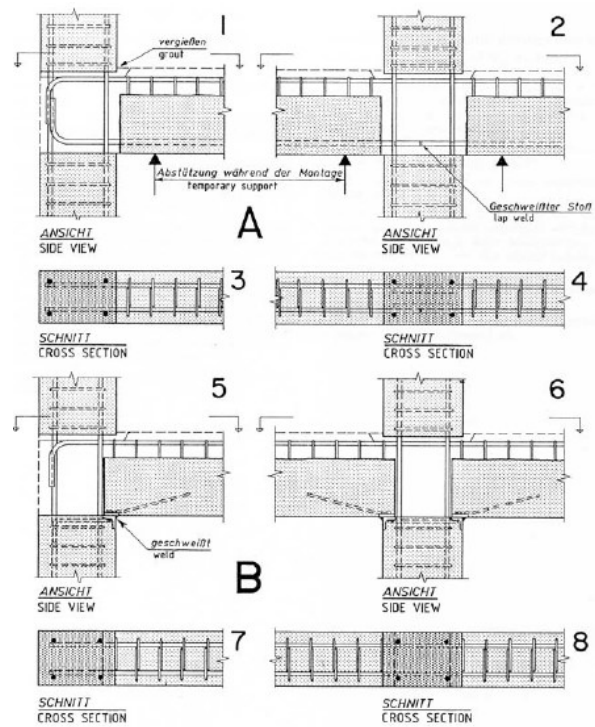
Interrupção de pilar com ligação por armadura e betonagem integral do nó (Stupré, 1981)
